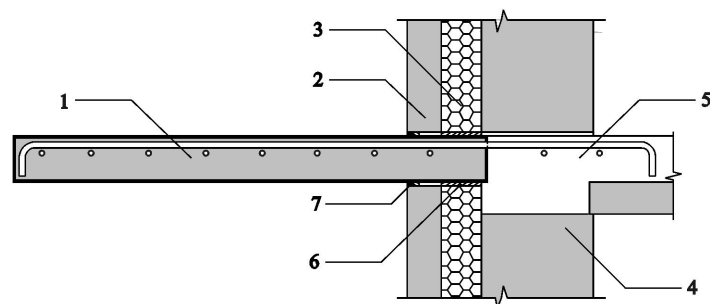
预制钢筋混凝土空调板连接节点示意
